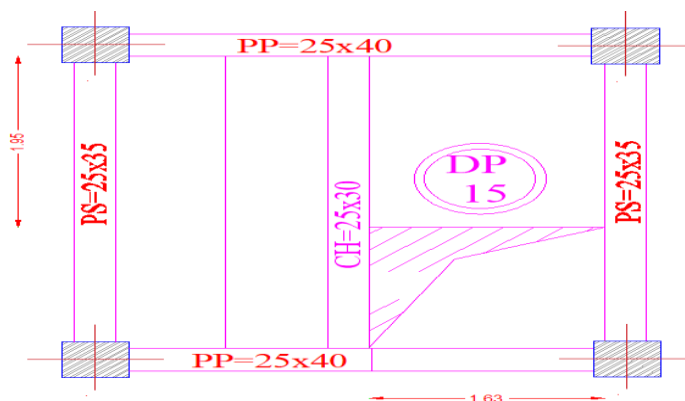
b.1 : Vue en plan dalle pleine hall ascenseur
